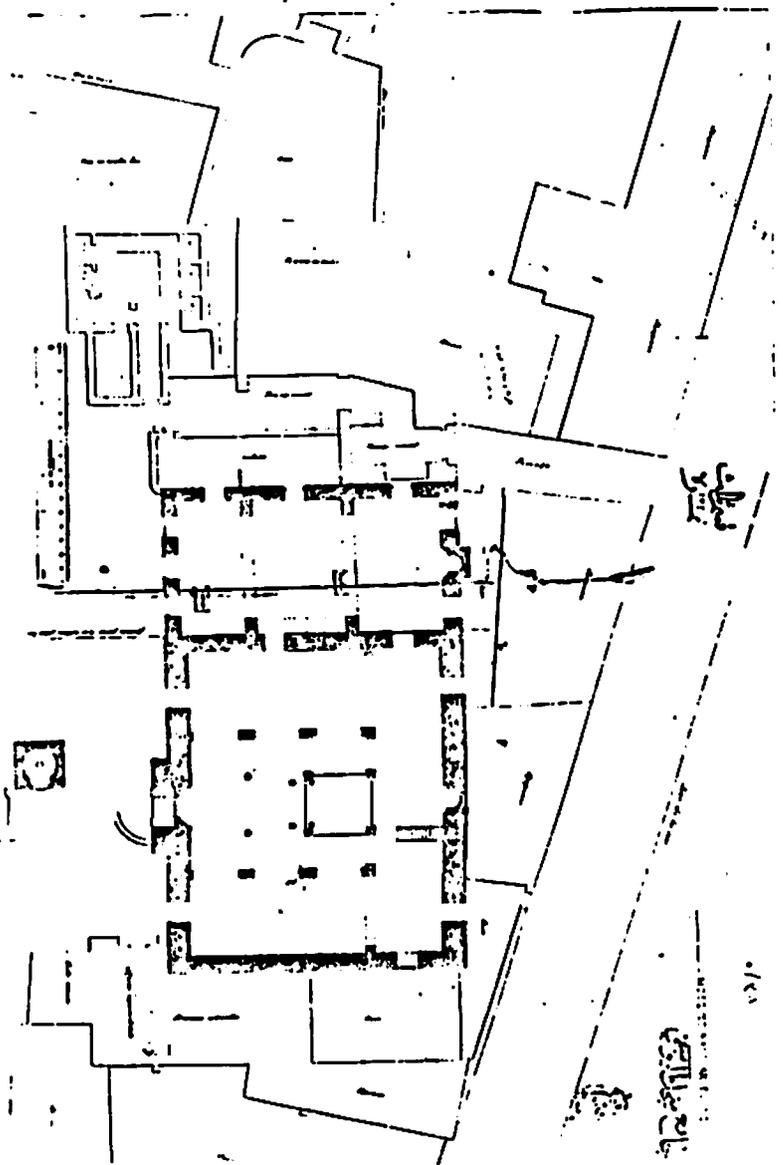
مسقط أفقى لمسجد ومدرسة وقبة أصلم البهائي عن محاضر
